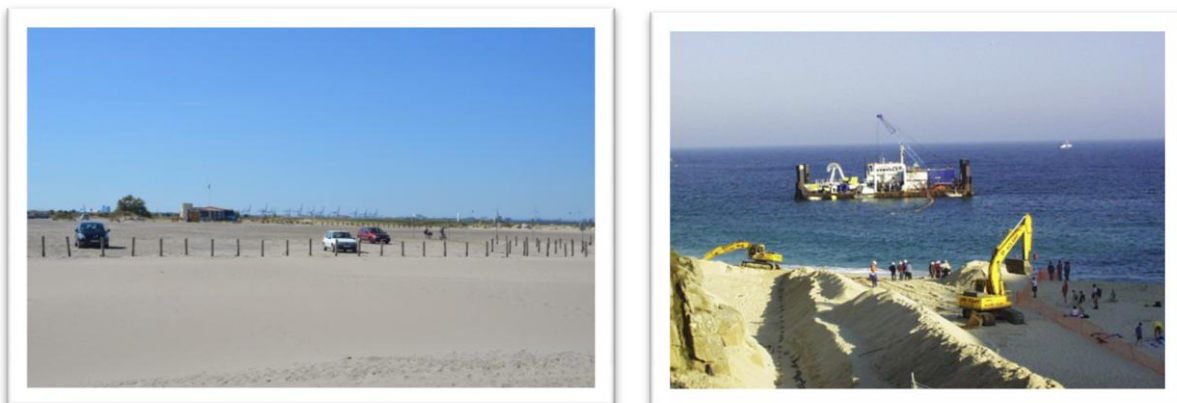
Site d'atterrage sur la plage Napoléon (parking) et exemple de chantier d'atterrage (Sources : BRLI, 2013 et EDF-EN)
